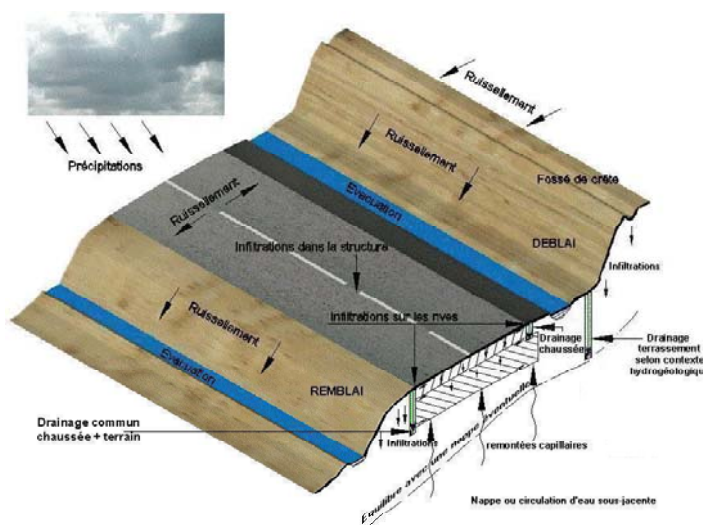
origine des infiltrations en eau dans une structure de chauss ee[2]
